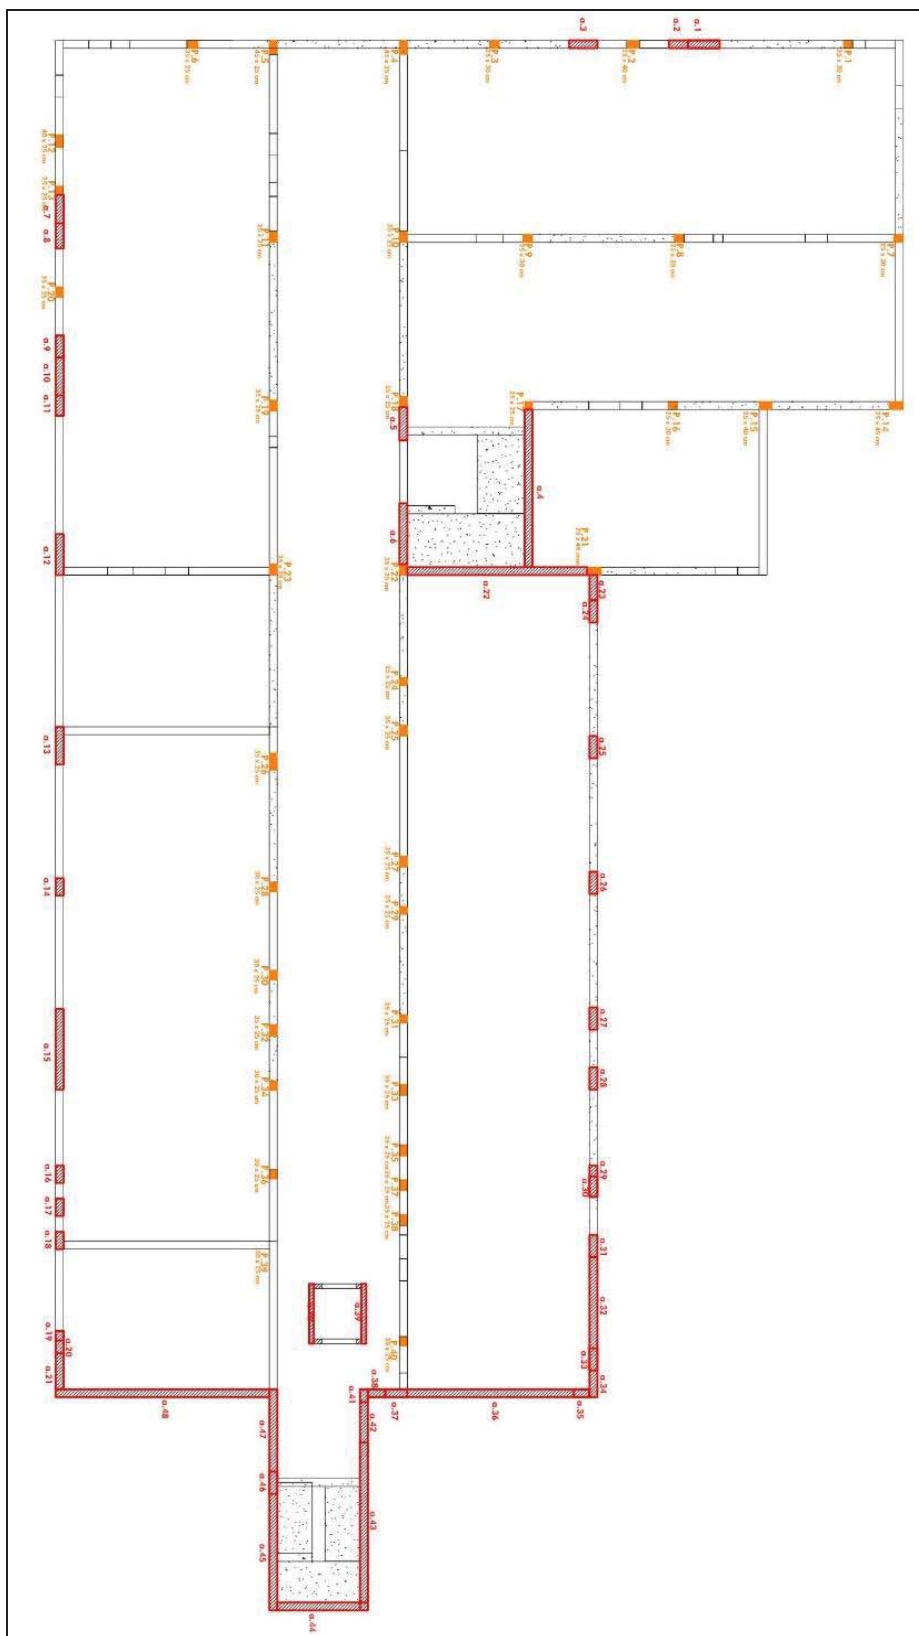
Pianta strutturale del piano terra, includente la numerazione dei setti in rosso e dei pilastri in arancione
